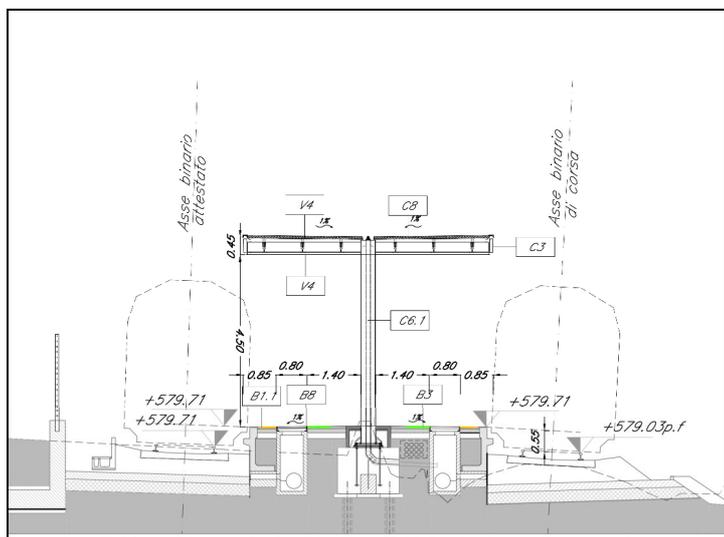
Sezione tipo banchina Stazione Cisternazzi
